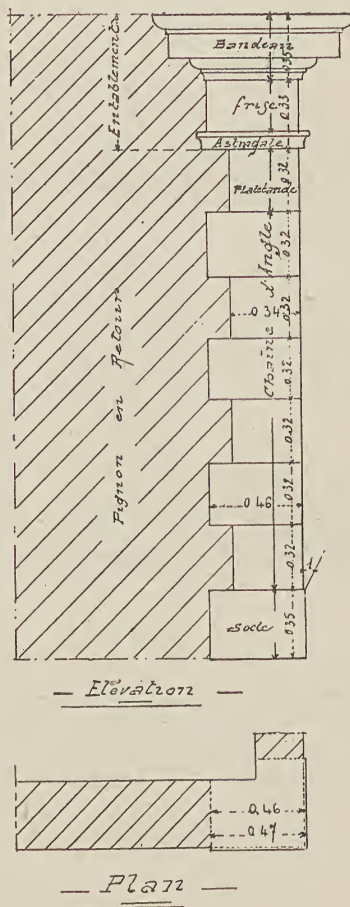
Plan et élévation de la chaîne d'angle en retour.
